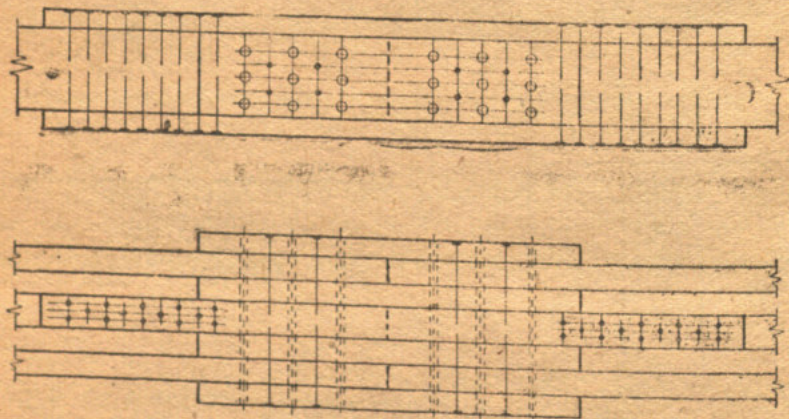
Усиление стыка на круглых нагелях дополнительными накладками на гвоздях.
